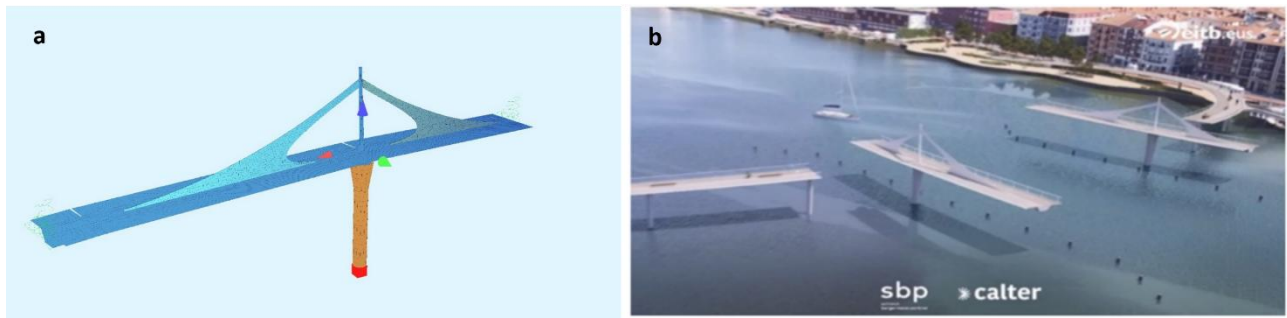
a) alzado parte móvil; b) infografía de puente abierto
